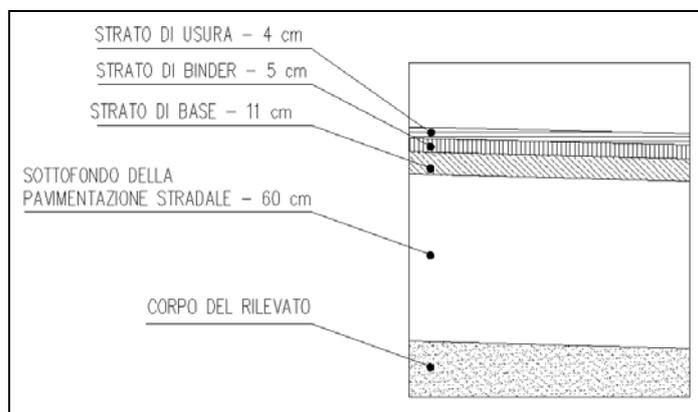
PARTICOLARE PACCHETTO STRADALE
